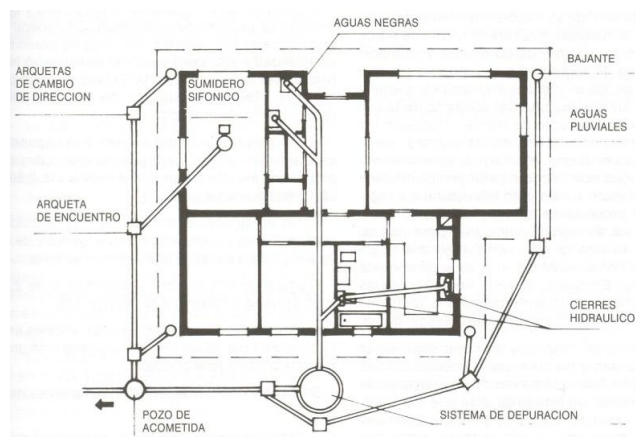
Alcantarillado separado (MAPAS, 2009).
